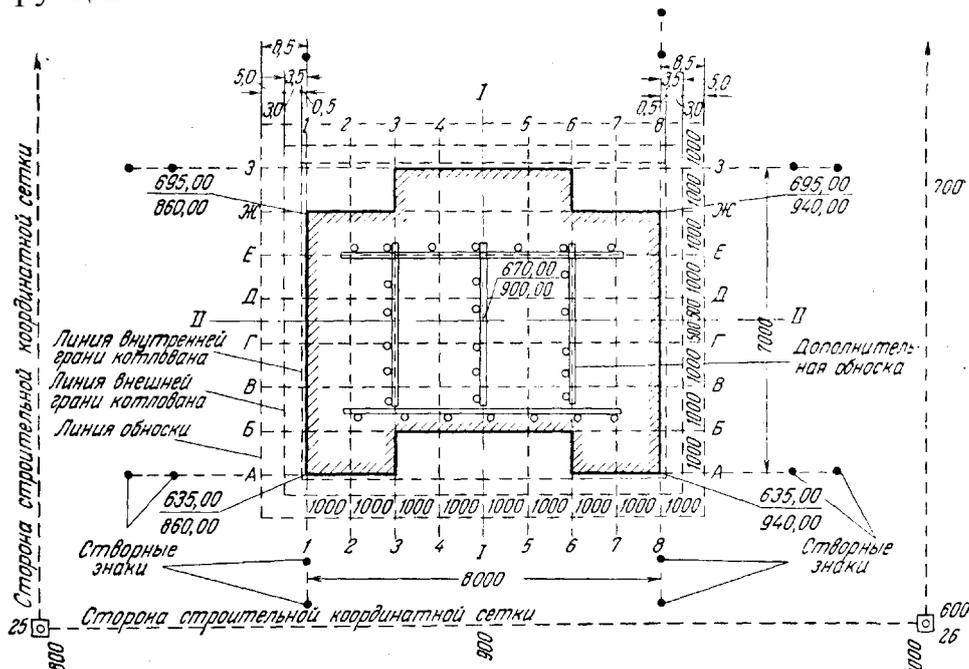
К детальной разбивке зданий и сооружений [1]
